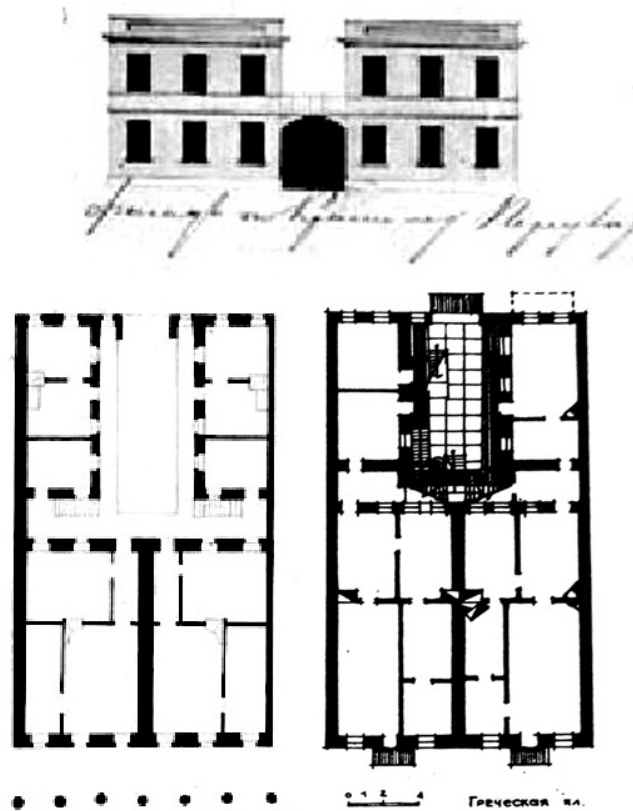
Фасад з боку Червоного пров. 24 та план I та II поверхів. Креслення Г.І. Торічелі, 1828 р. [21]
